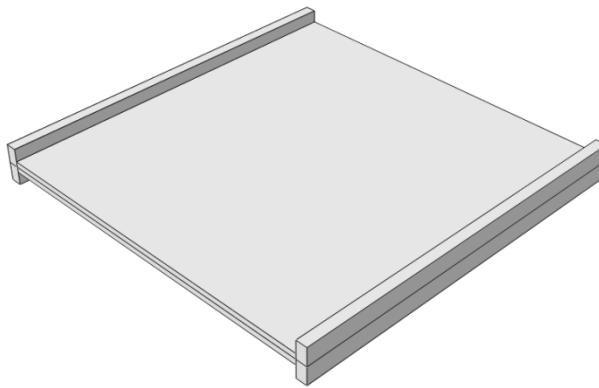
Plaque rectangulaire appuyée élastiquement sur deux poutres
